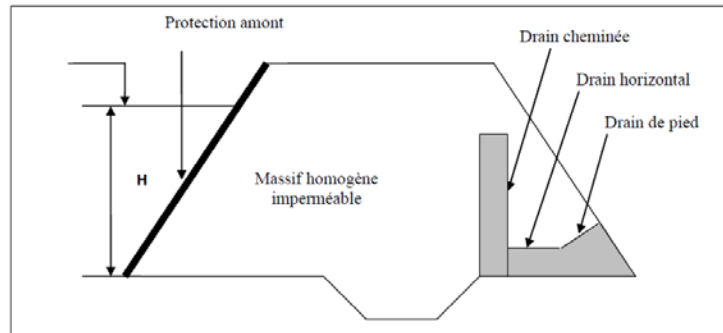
Système de drainage dans un barrage en terre (Femmam, 2011).
